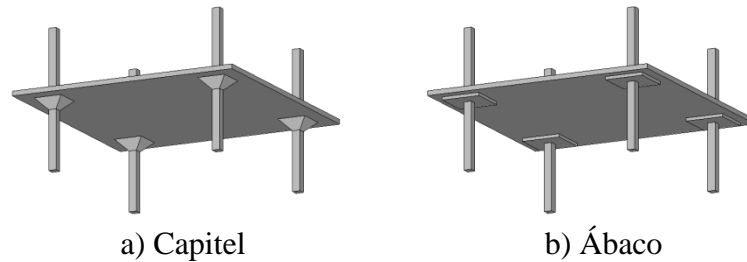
Lajes cogumelo [adaptado – FERREIRA (2010)]
